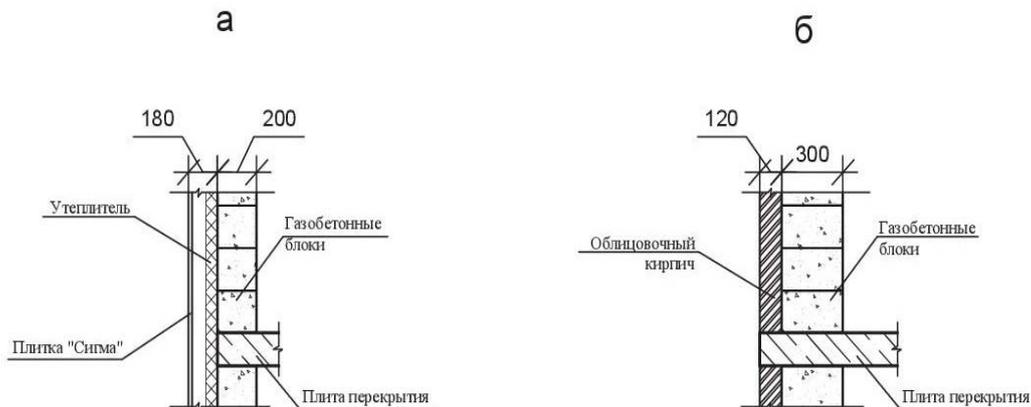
Типы облицовки наружных стен: а – облицовка навесным вентилируемы фасадом; б – облицовка кирпичом
